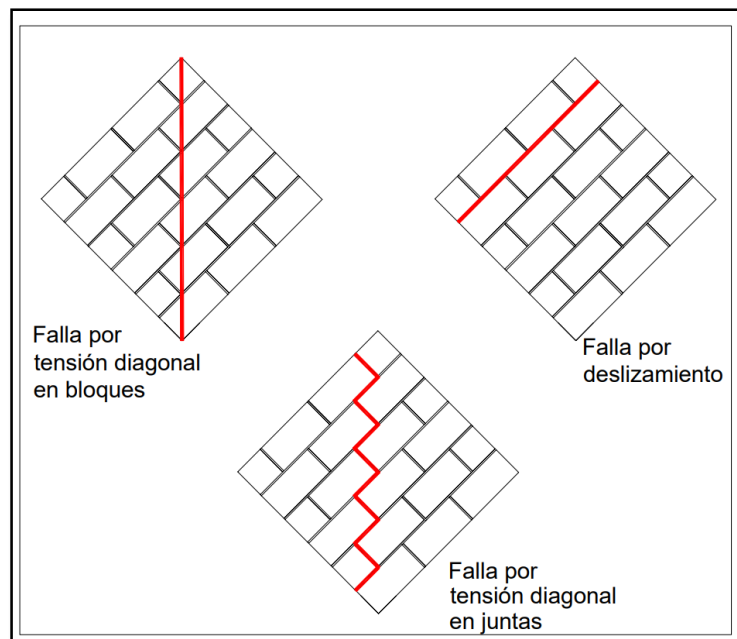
Tipos de fallas en los muretes sometidos a ensayo de compresión diagonal.
